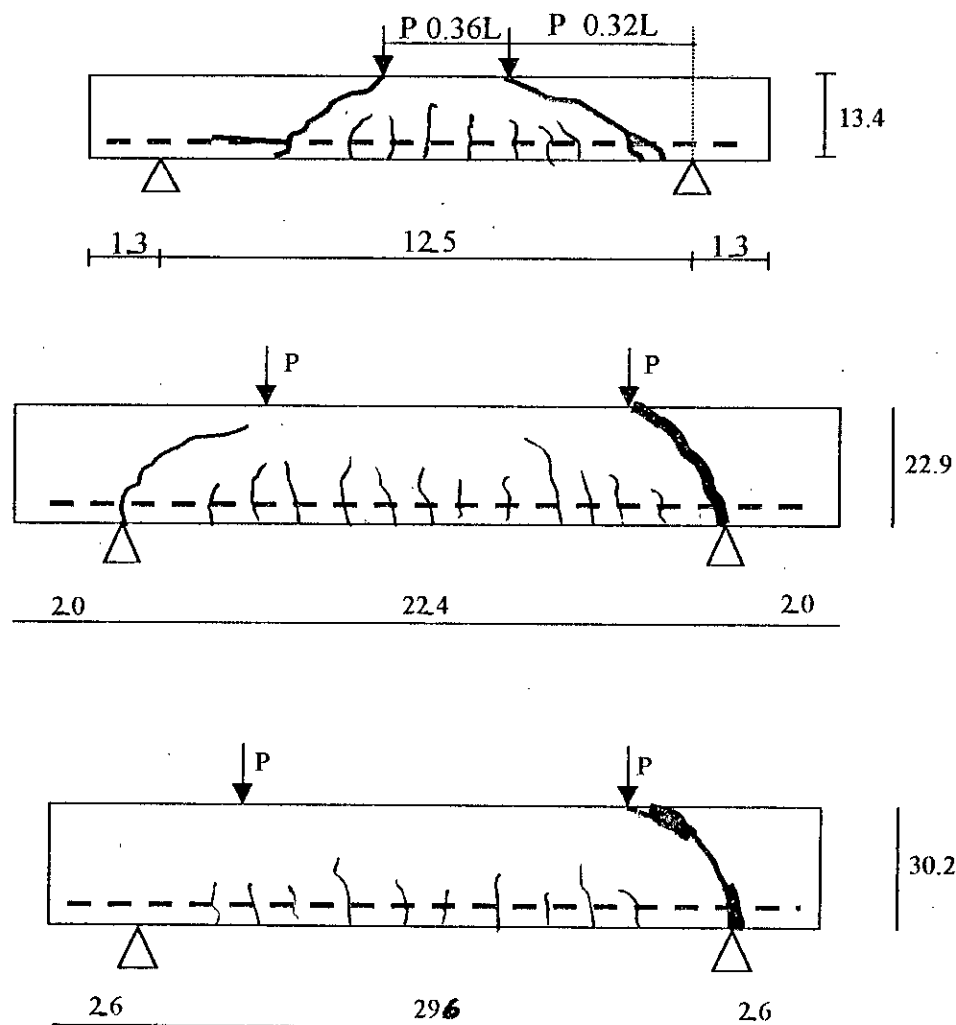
influence des dimensions absolues d'une poutre sur la morphologie des fissures, d'après les essais de RÜSCH, HAUGLI, MAYER
